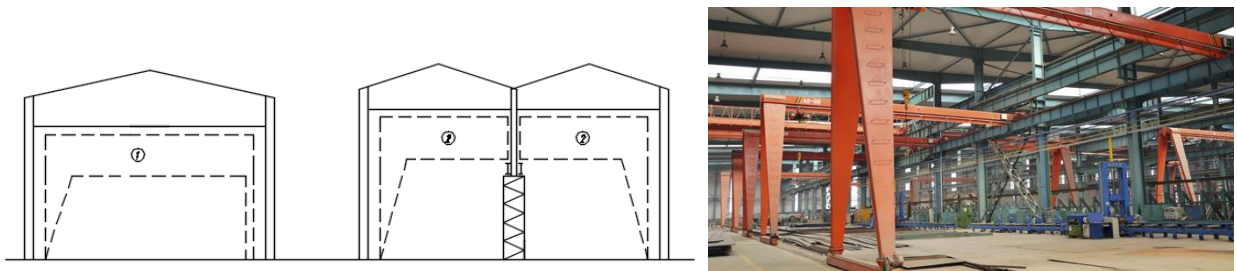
Поперечні рами з напольними кранами [2]:
